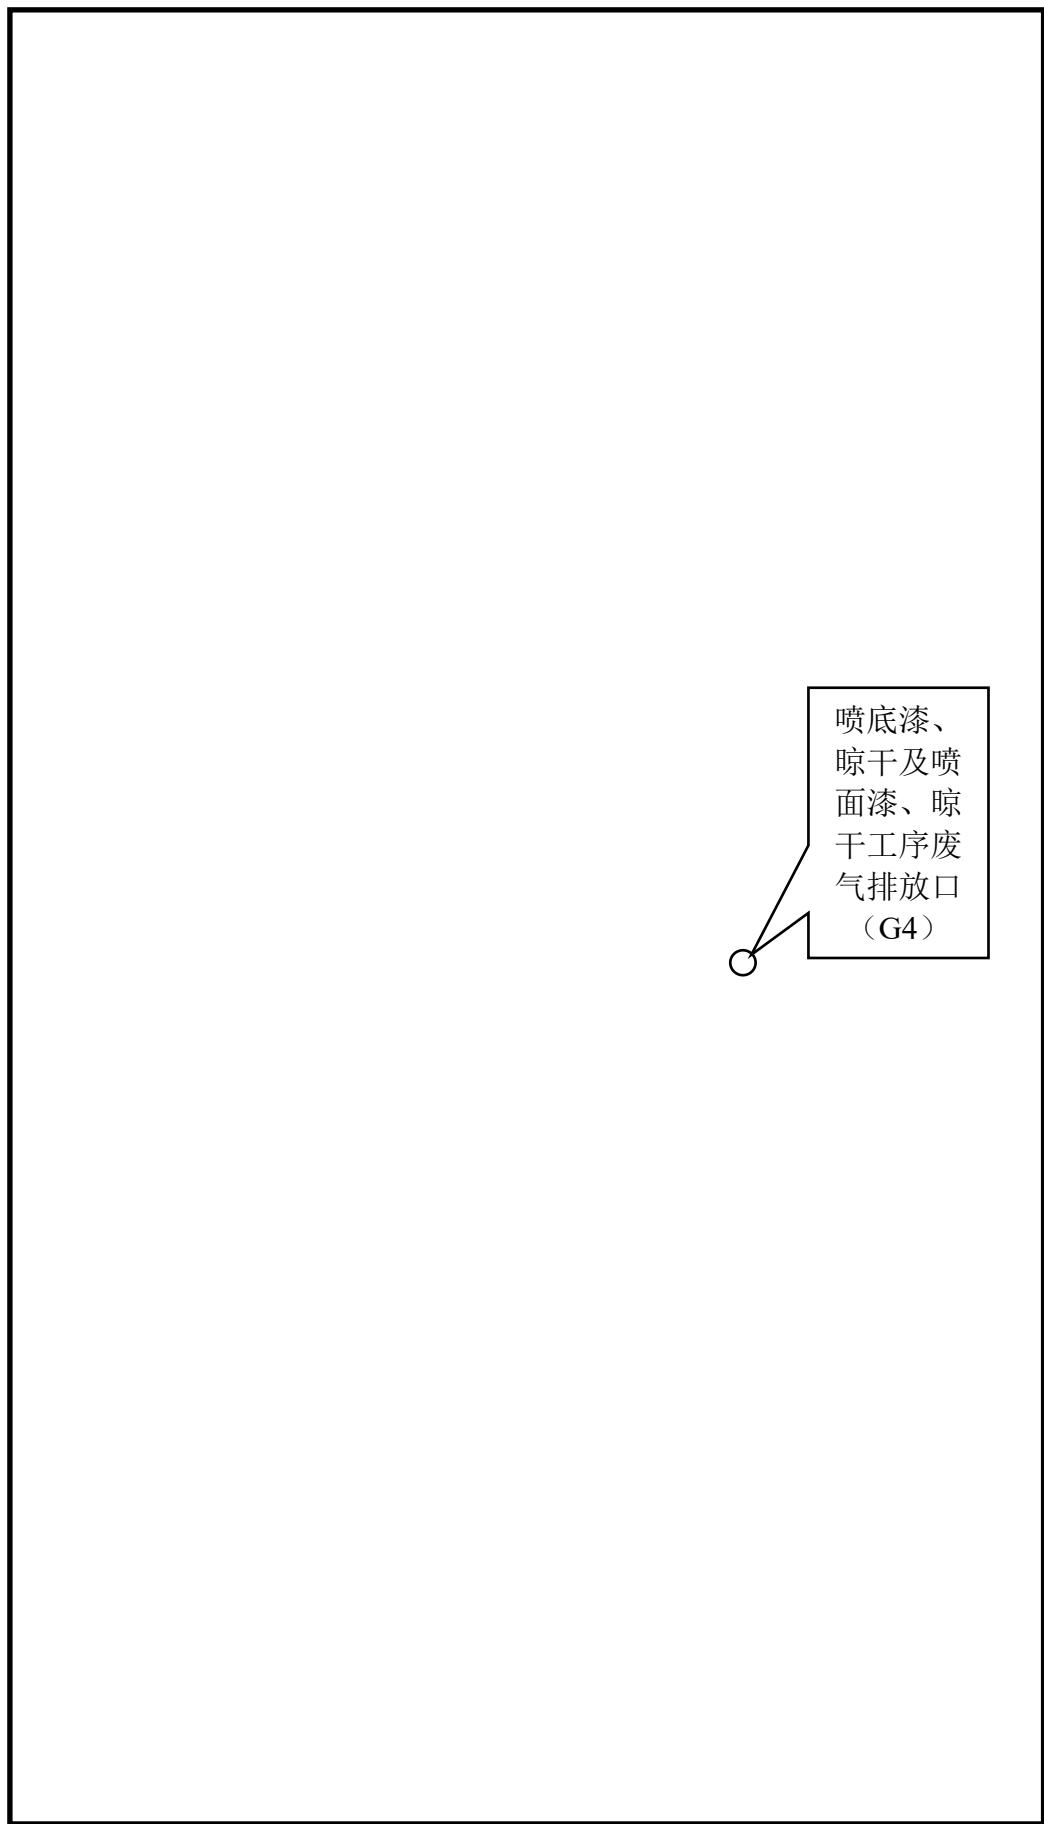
项目二期 B 栋平面图 (顶楼天台)
